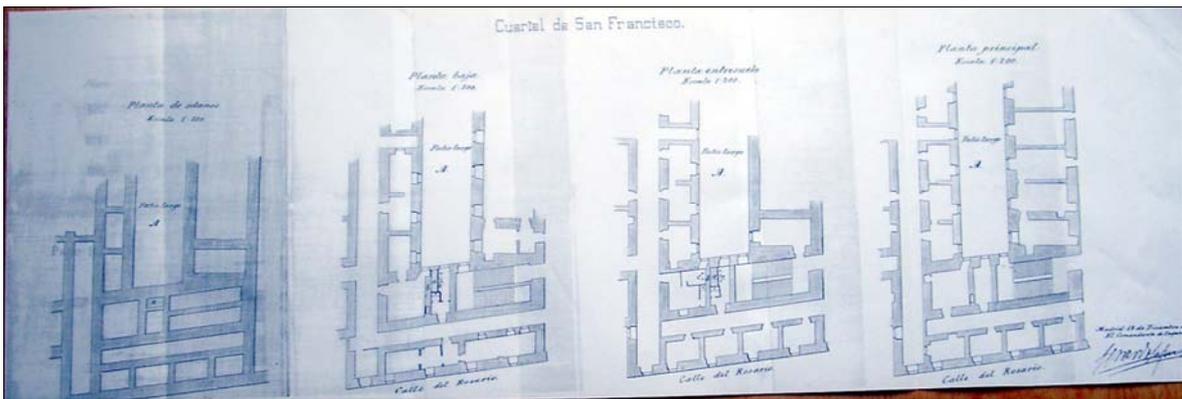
Cuartel de San Francisco. Levantamiento planimétrico de los distintos niveles que componen el área del Patio de Llerena: sótanos y plantas baja, entresuelo y principal. Escala original, 1:200. Archivo General Militar, Sección 3ª., división 3ª., leg. 580.
